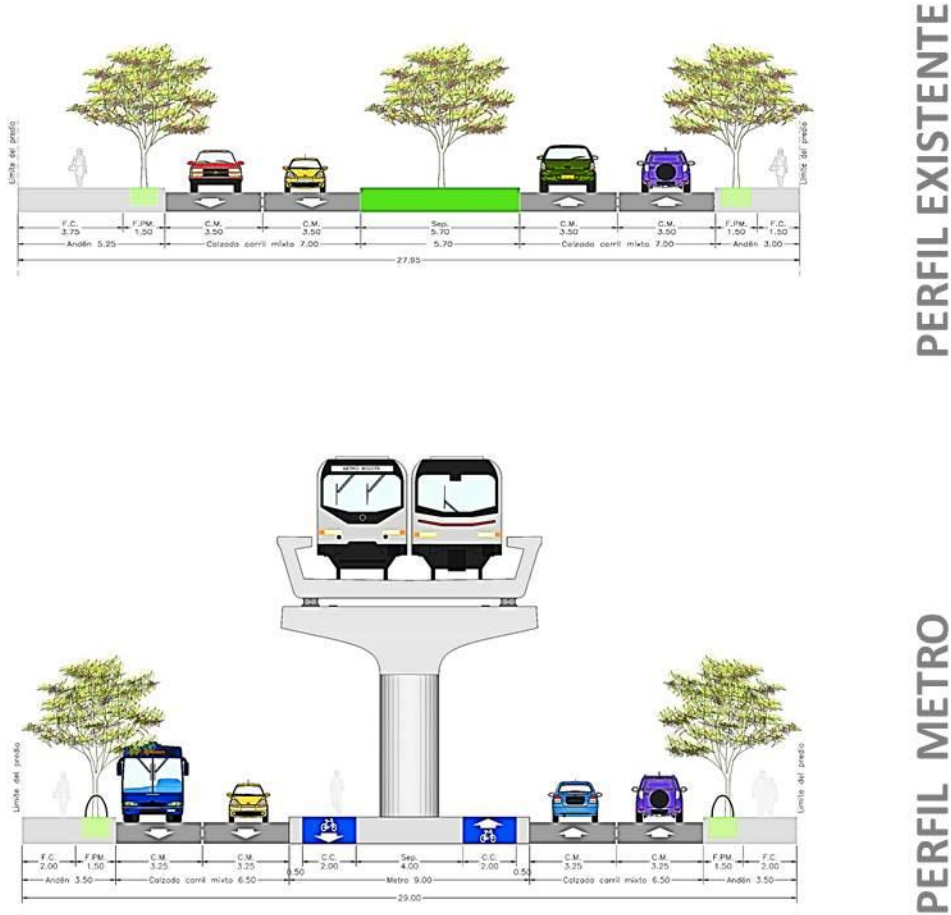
Sección transversal en la Avenida Octava Sur entre la Avenida Norte Quito Sur (NQS) y la Carrera 27. Fuente: Elaboración Propia 2017. Imagen representativa, urbanismo puede variar según la zona (
